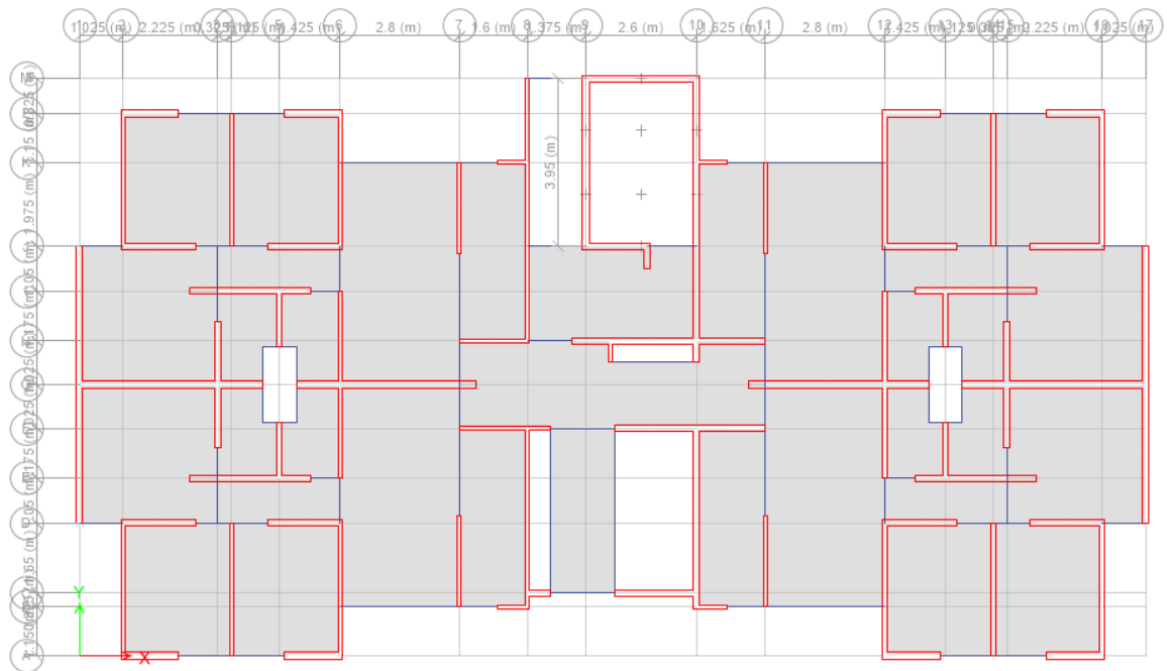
Disposición de elementos estructurales (Planta típica) Sistema MDL - Edificio Blesser. Fuente: Elaboración Propia.
